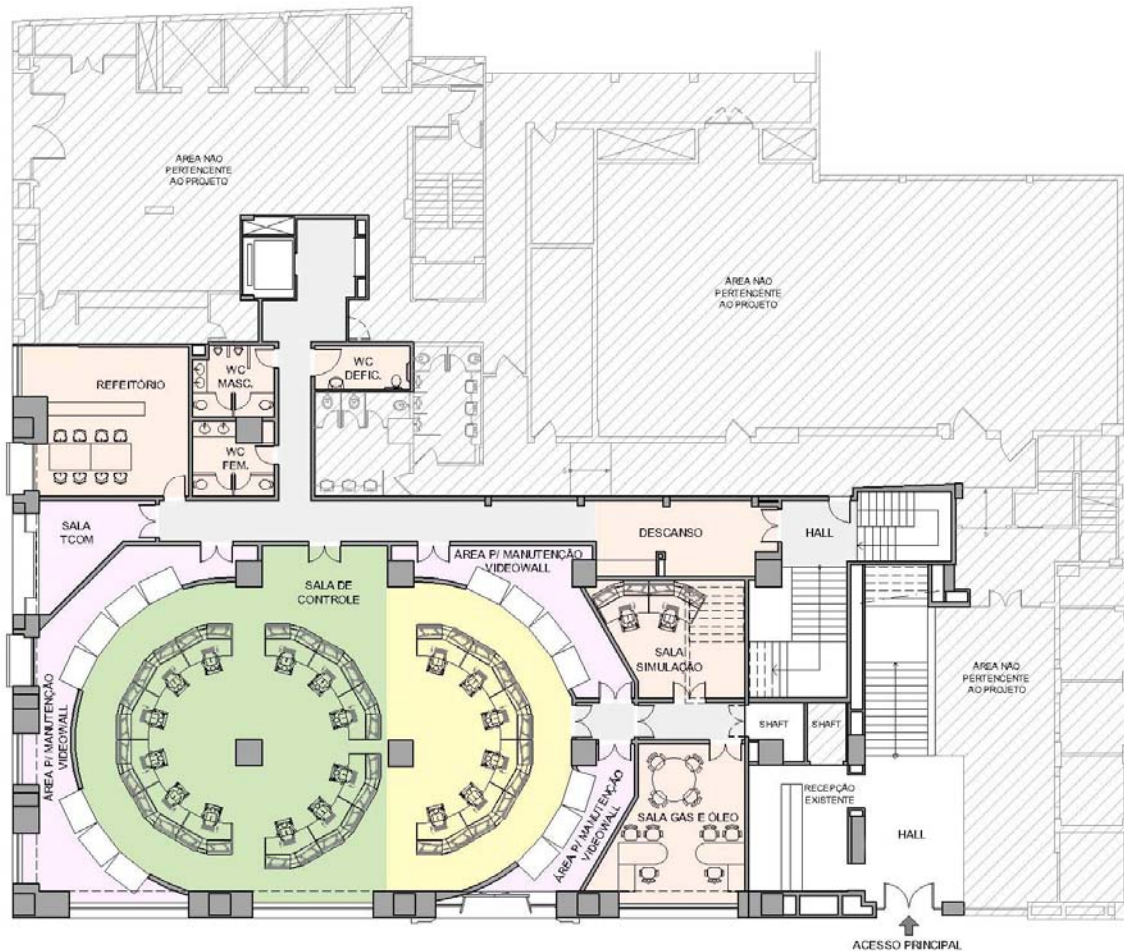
Planta baixa pavimento térreo: layout circular elaborado em seis de julho
